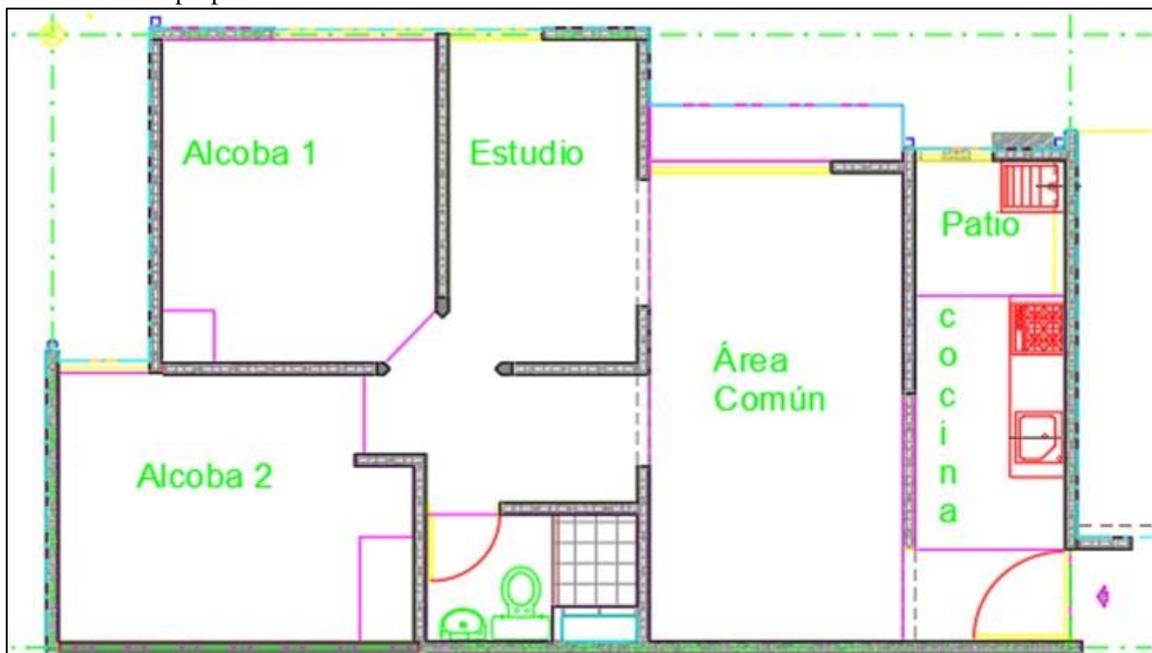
Plano Arquitectónico VIP - Modelo 2 – Valle del Sol
